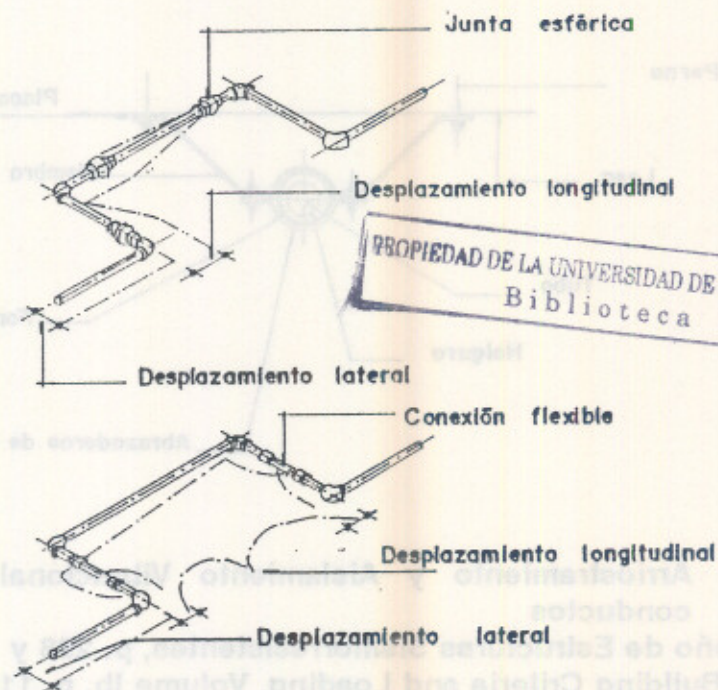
Detalles de tuberías que cruzan juntas sísmicas
